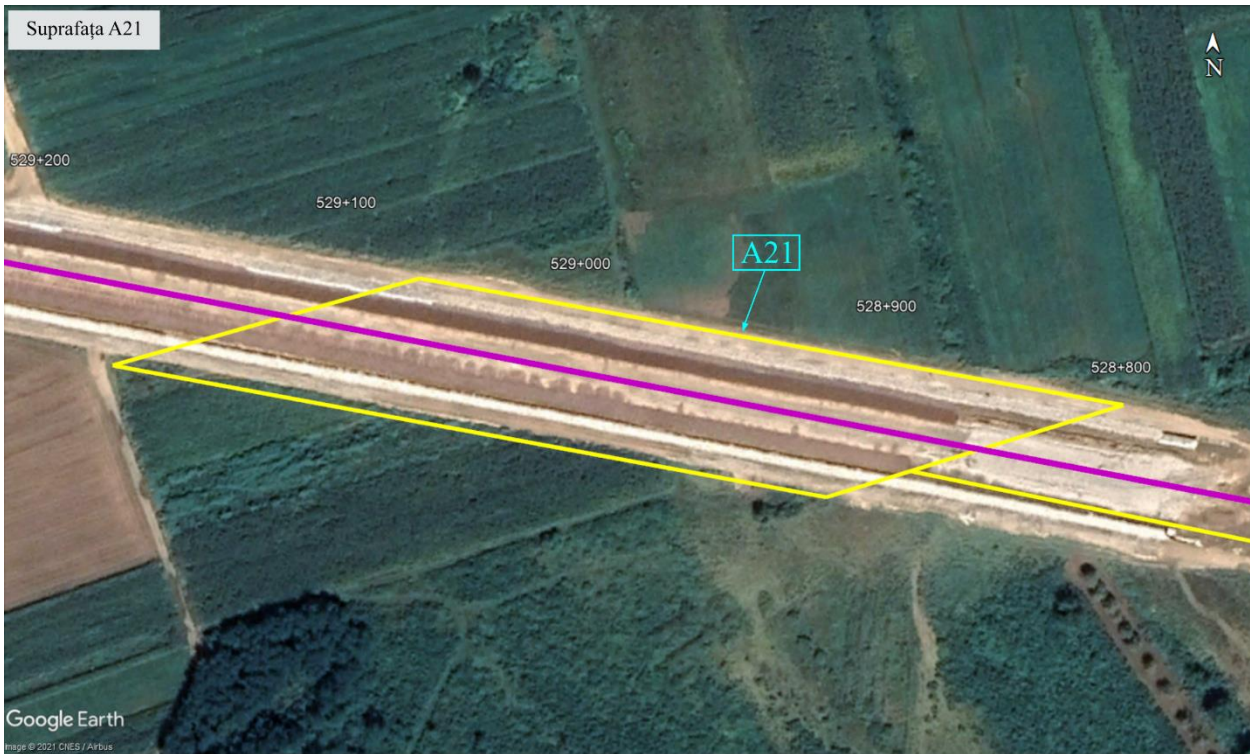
Plan de amplasament pentru suprafața expropriată A21, jud. Arad – vedere din satelit
